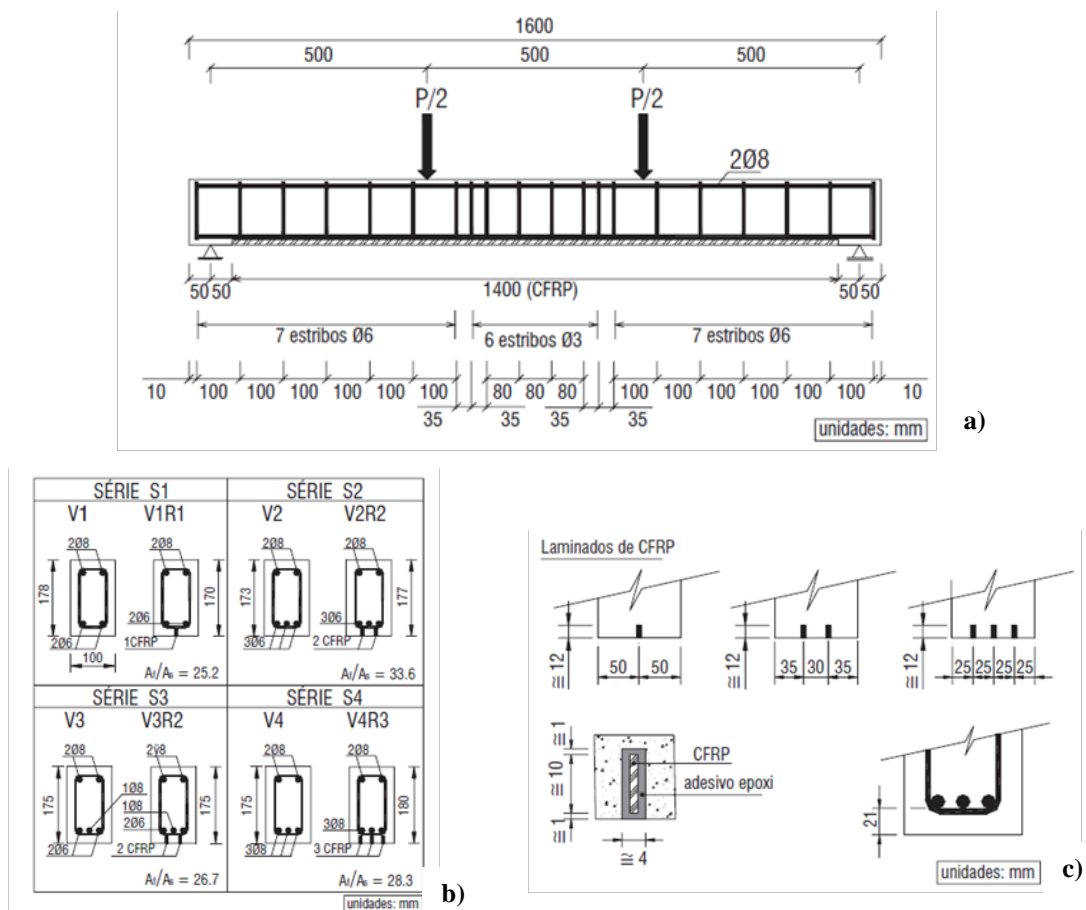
Séries de vigas testadas: a) tipo de carregamento e distribuição das armaduras; b) secções transversais; c) pormenor do reforço de CFRP (Barros *et al.*, 2007).
